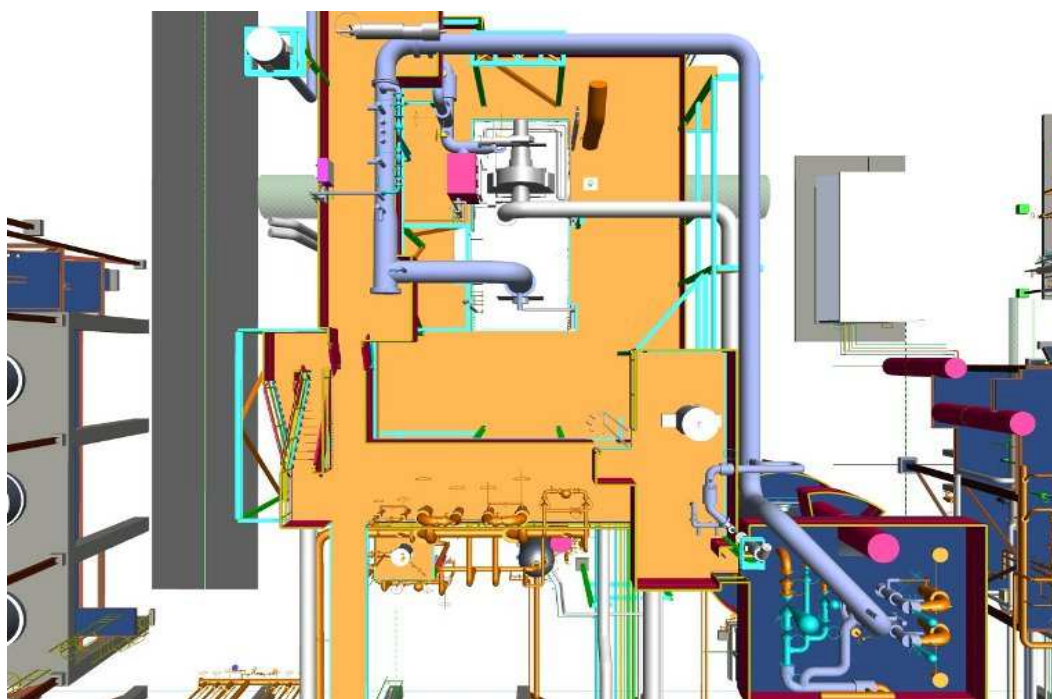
Disposición de Tuberías Alrededor de Compresores Centrífugos- Vista en Planta
